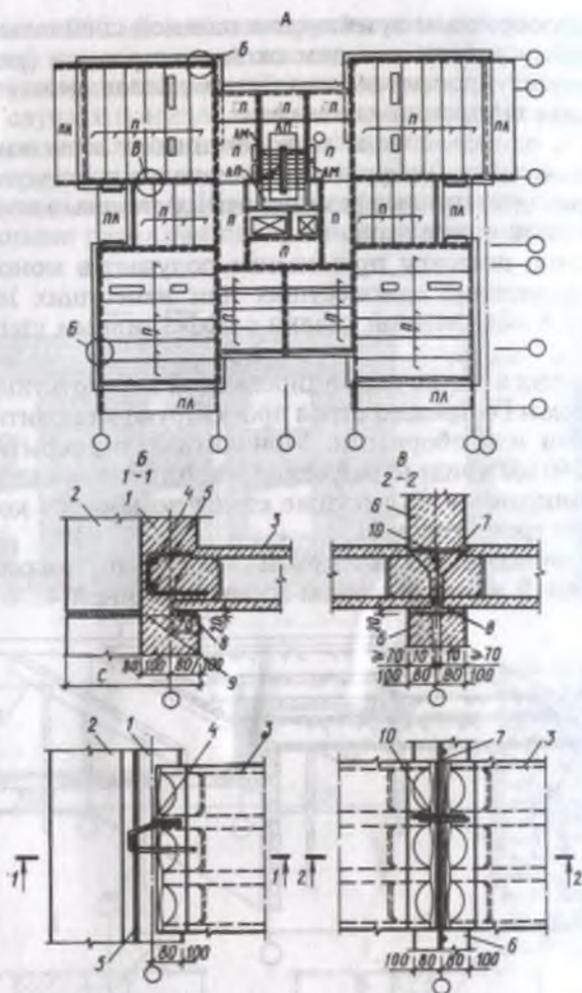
Сборное перекрытие из многупустотных железобетонных плит:
